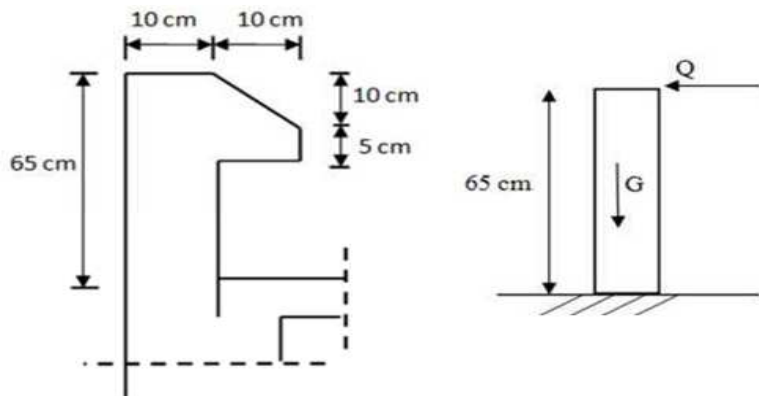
Coupe transversale et schéma statique de l'acrotère.
